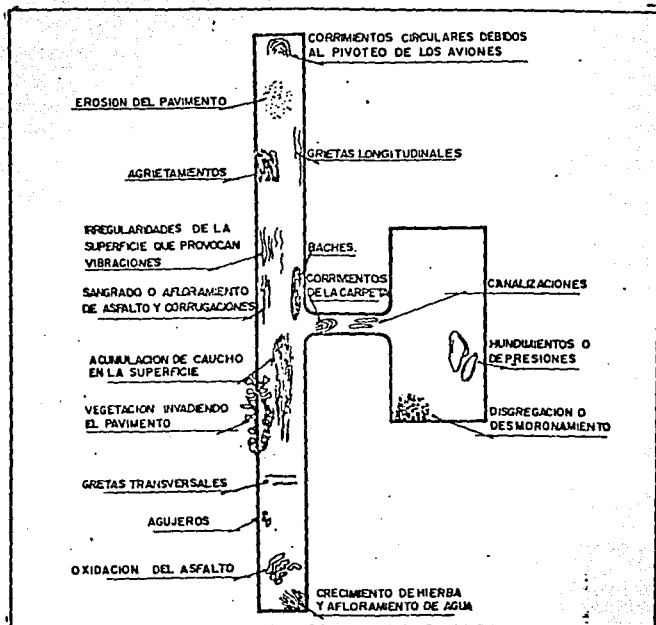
Conservación y detalles a observar en pavimentos flexibles.
